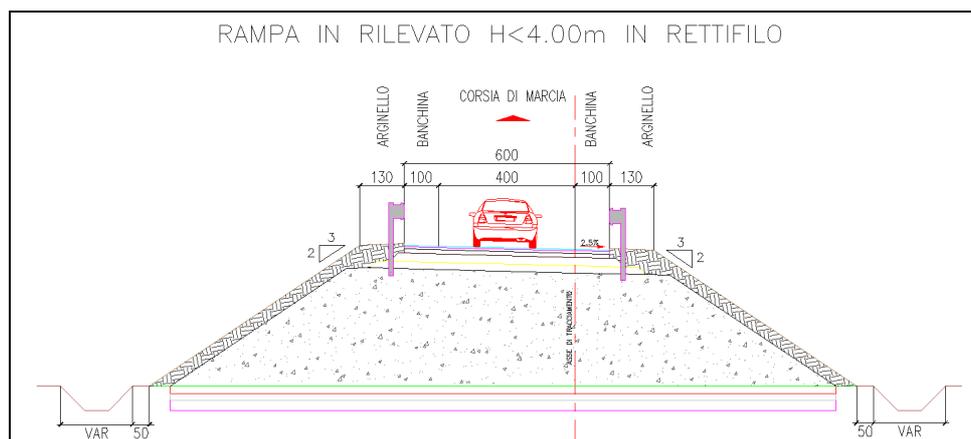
SEZIONE TIPO RAMPA DI SVINCOLO
